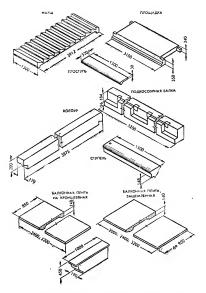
Сборные железобетонные элементы лестниц и балконов.
